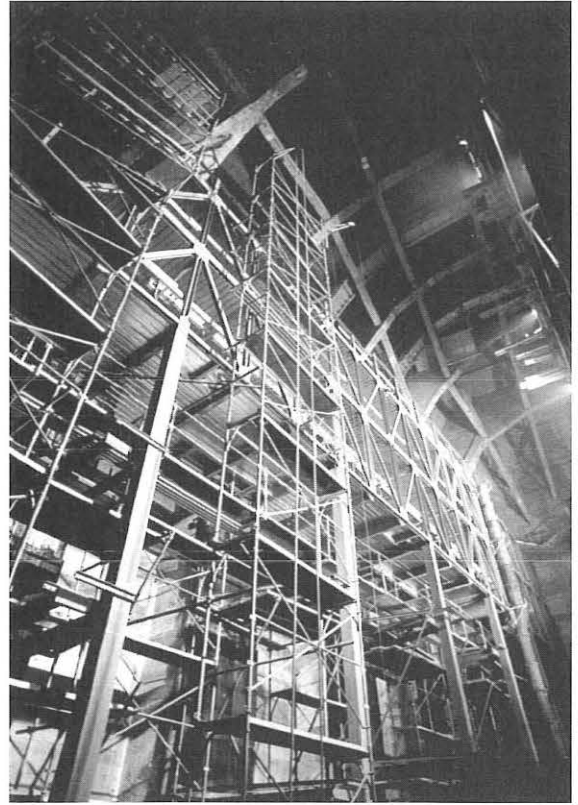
Tragendes Gerüst aus Stahlprofilen an der Saalwand
